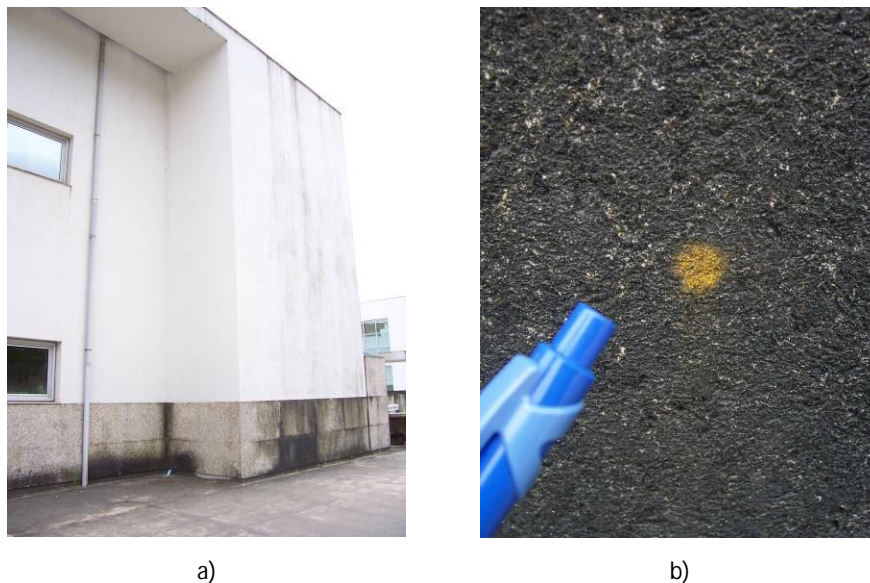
Fachada revestida a placas de granito, de edifício construído em 1997, no Campus de Gualtar. Lado norte. a) Zonas constantemente húmidas, próximas do pavimento; b) Líquenes formados na fachada e próxima do pavimento.
